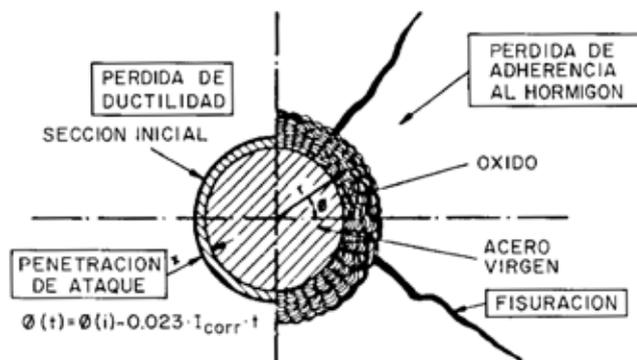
Consecuencias del deterioro sobre el hormigón armado.
